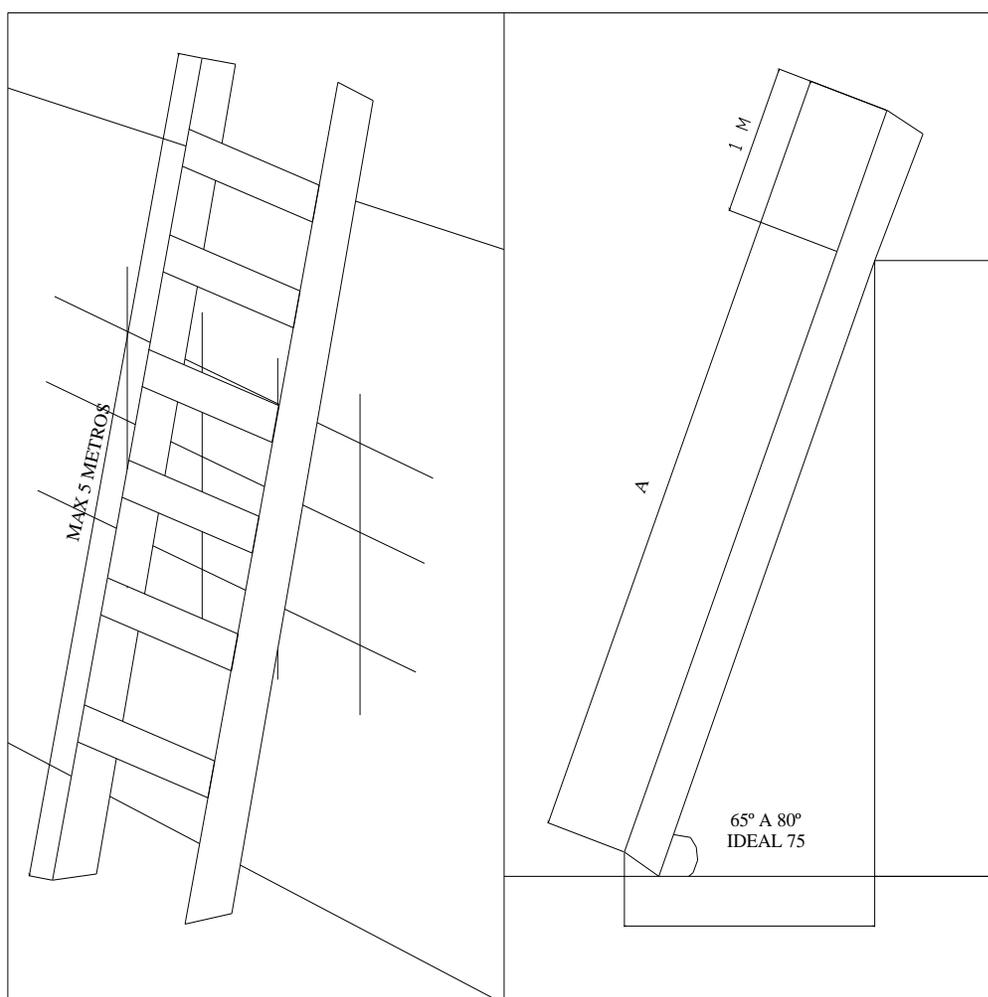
El ángulo que forma con el piso debe ser de 75° .
